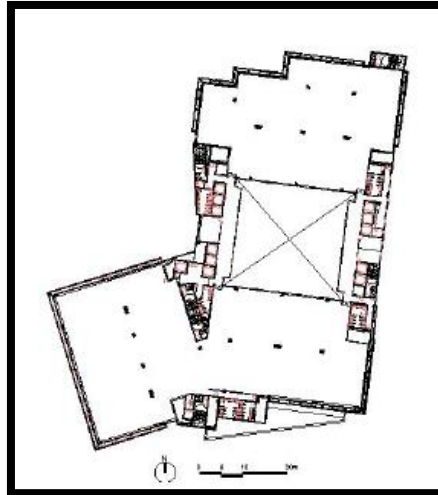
Planta-baixa do pavimento tipo do Edifício Cidade Nova.
